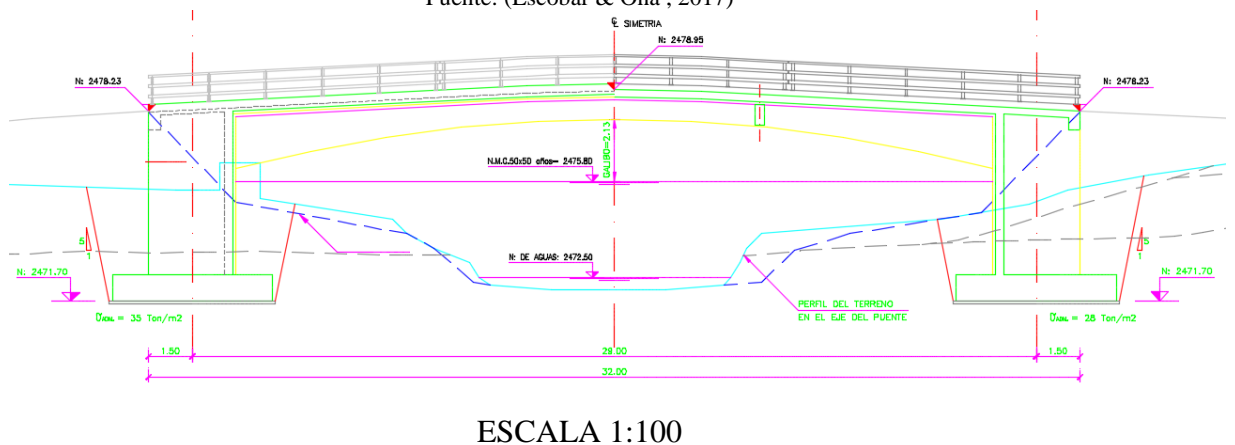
Vista en elevación del puente de hormigón armado Isla Genovesa.
